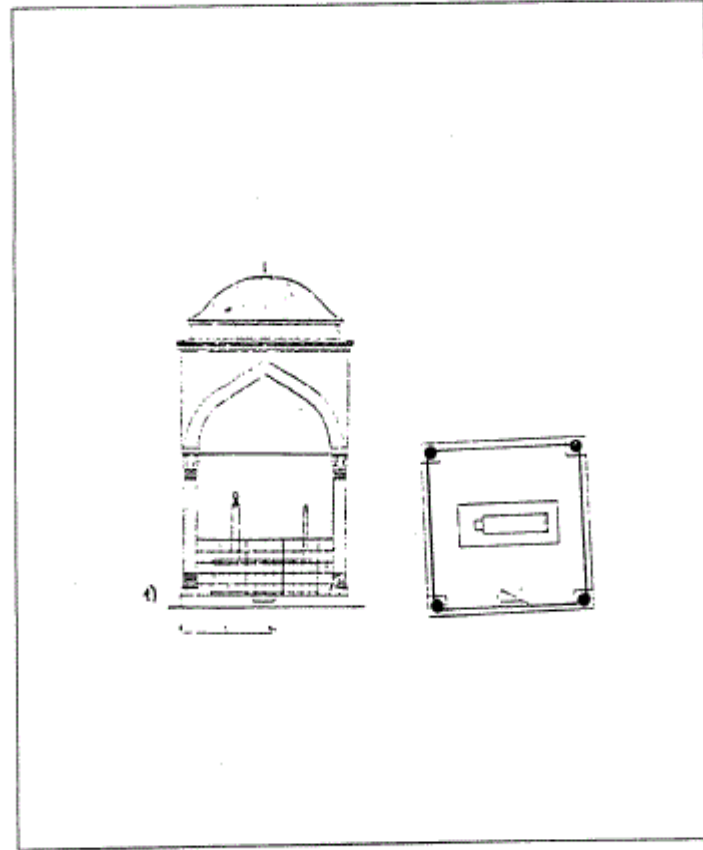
مسقط أفقي لثربة KidemLi Baba في نوافزاجورا ببلغاريا (عن : كيل) .
